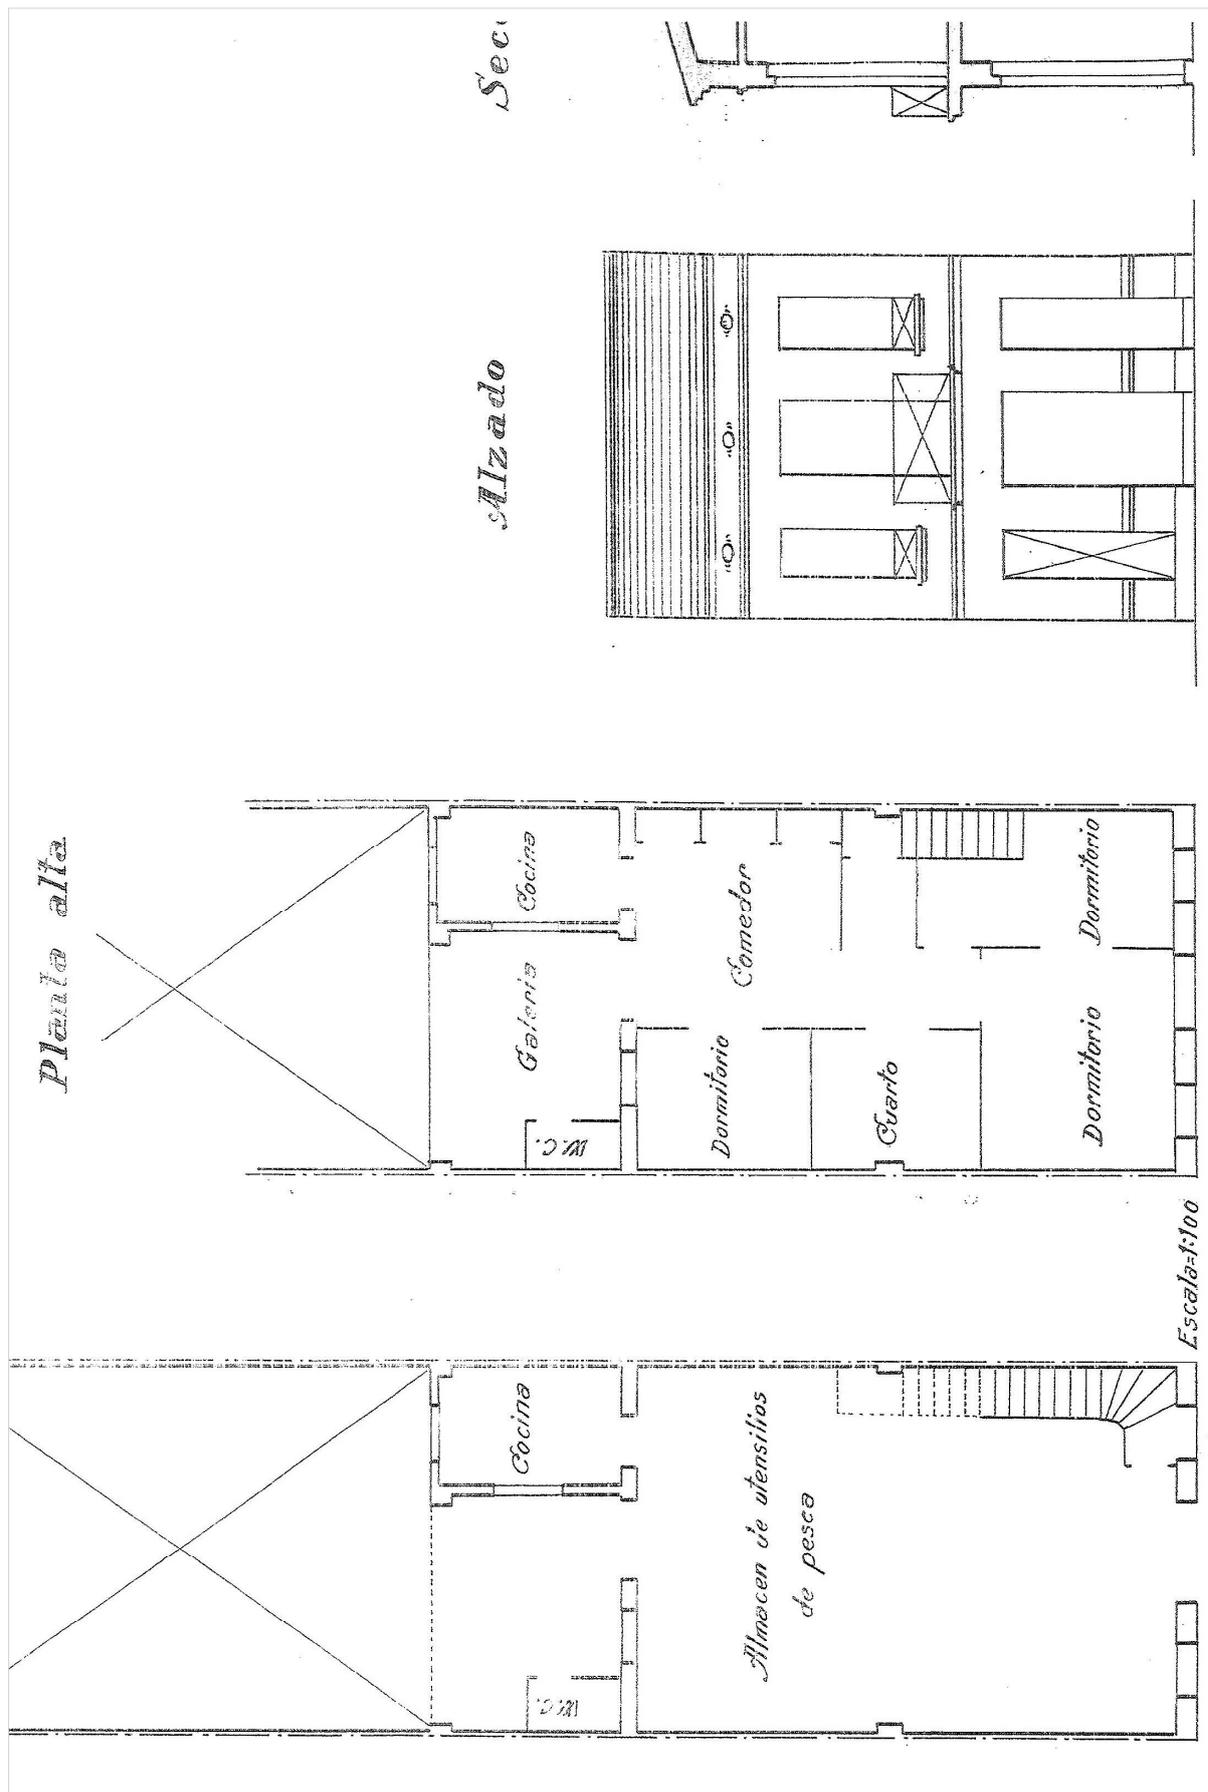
Planos de plantas, alzados y secciones, Grupo A. Fomento PU. Exp. 33.622 Año 1929 Caja 18
